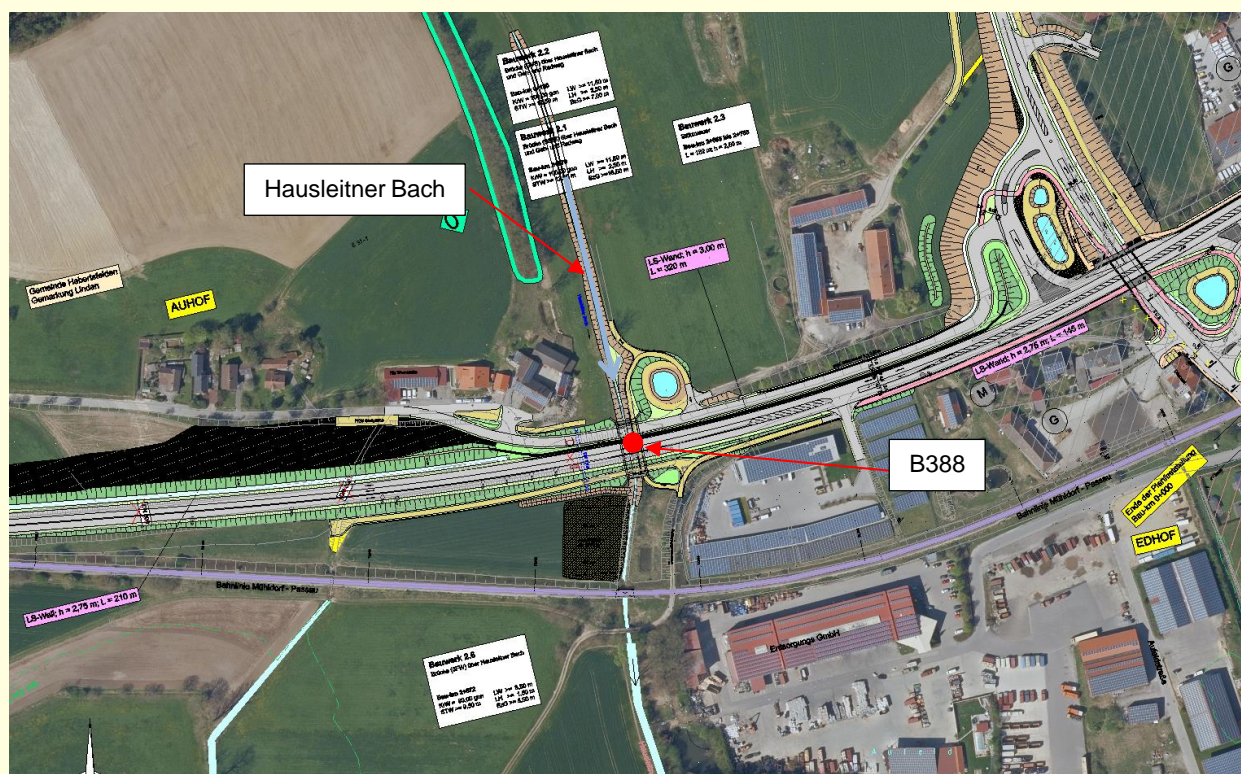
Lageplanauszug. Planung mit einem Rahmenbauwerk über den Hausleitner Bach. Planstand September 2024.
